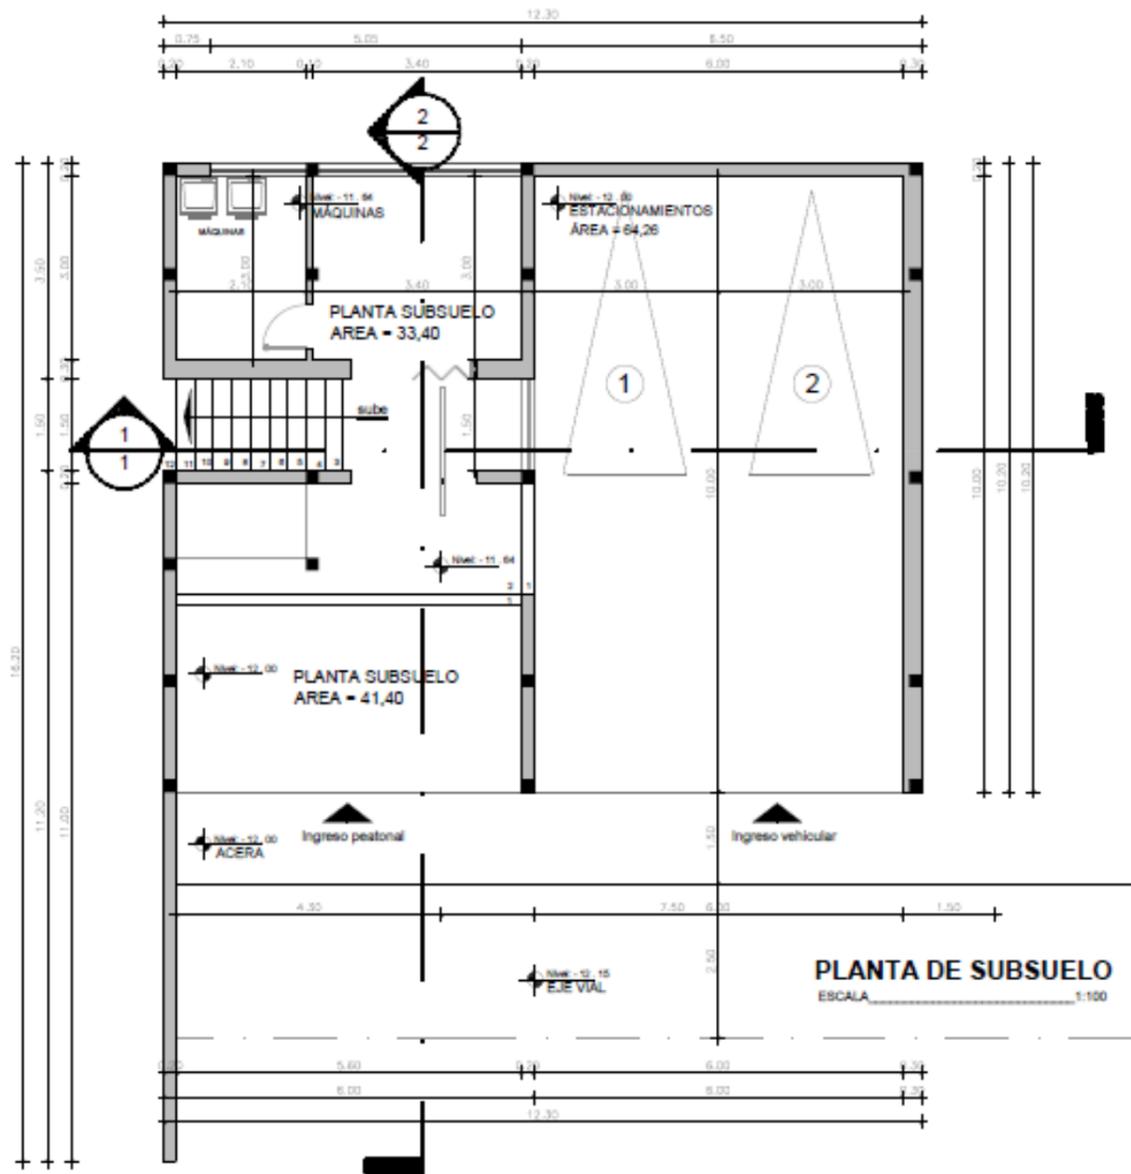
Planta de Subsuelo Casa 14 proyecto “El Peñón del Río”
